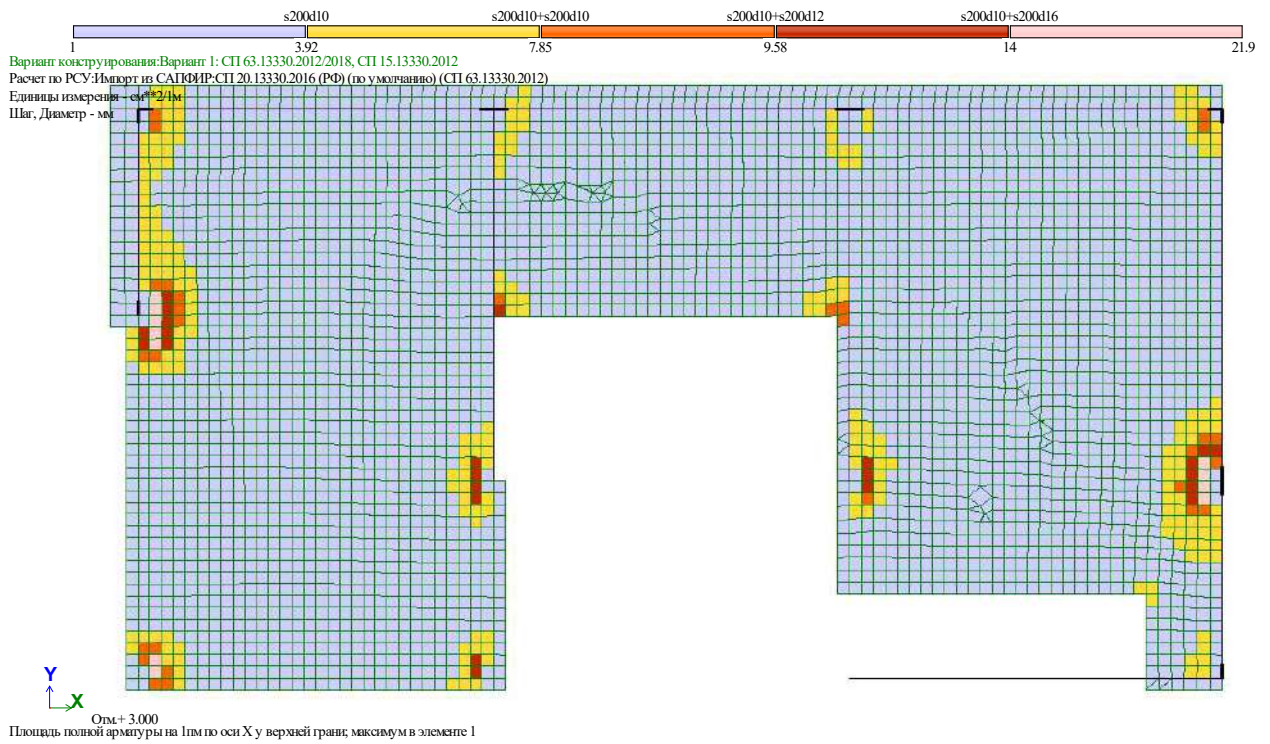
Мозаика армирования верхней арматуры вдоль б.о.
